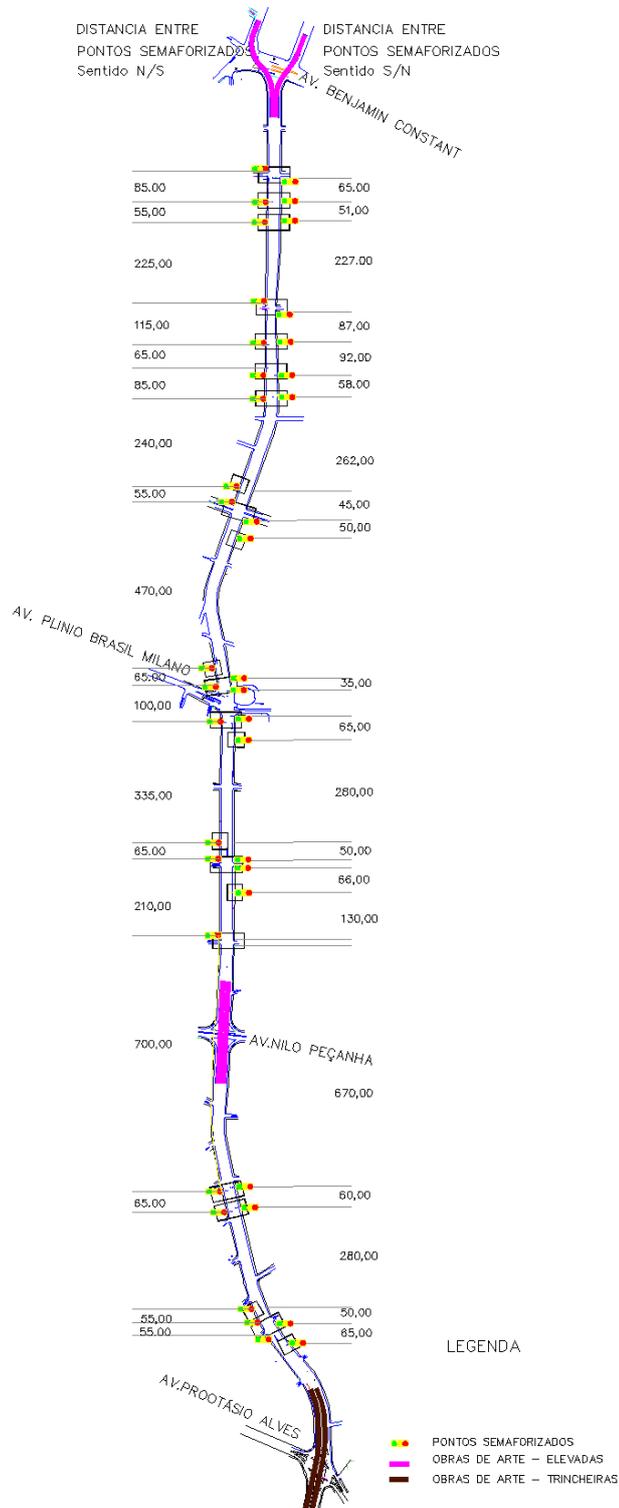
Locais com o trânsito controlado por semáforos e distância entre cada ponto semaforizado – trecho entre Av. Benjamim Constant e Av. Plínio Brasil Milano.
